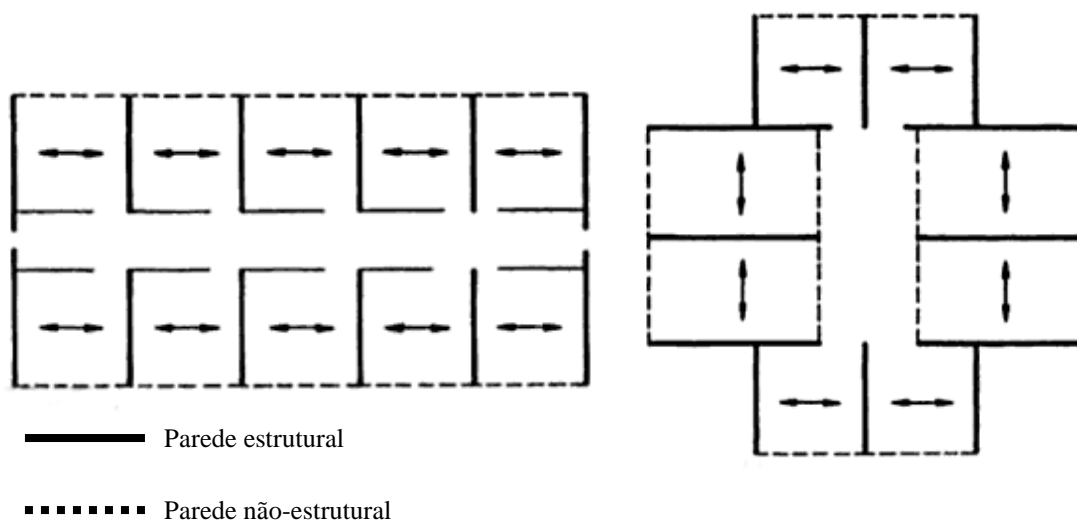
sistema de paredes transversal simples e duplo. Fonte: HENDRY, 1981.
